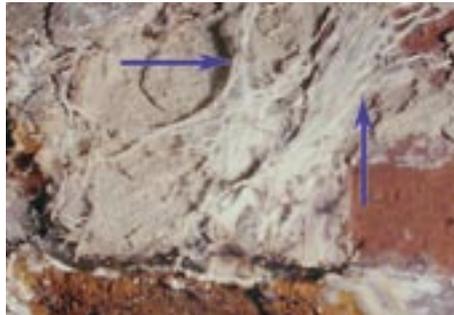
Stränge versorgen einen Fruchtkörper des Echten Hausschwammes und durchziehen Mauerwerk (→↑); Mauerwerk aufgeschlagen.
